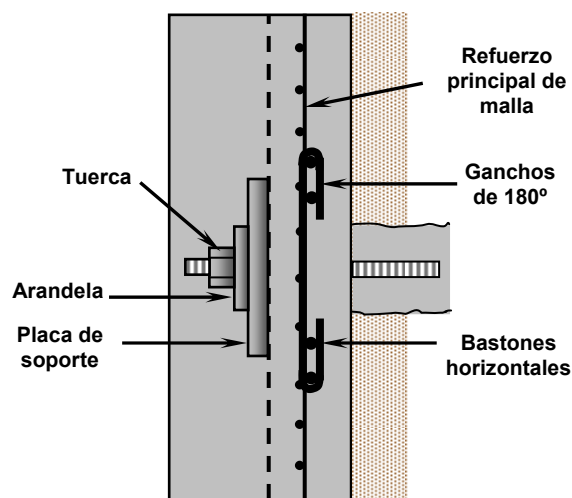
Utilización de ganchos de 180° en armado de soil nailing.
